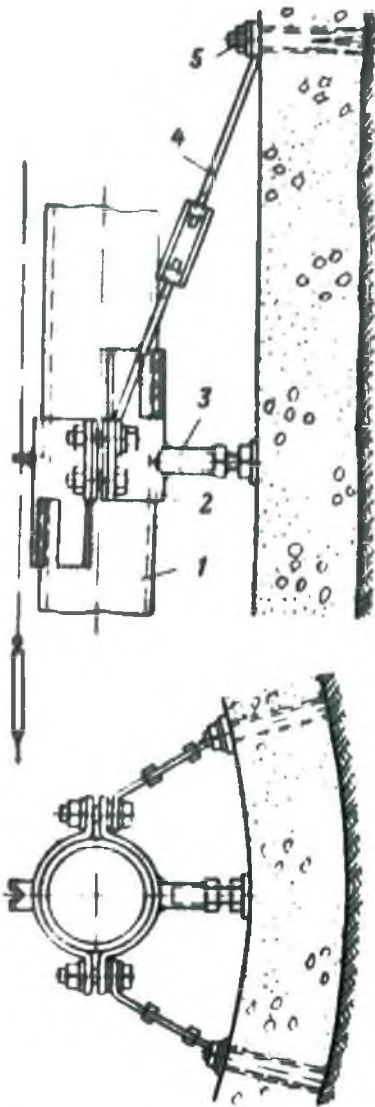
Узел соединения и подвески труб бетонопровода к стенкам ствола:
